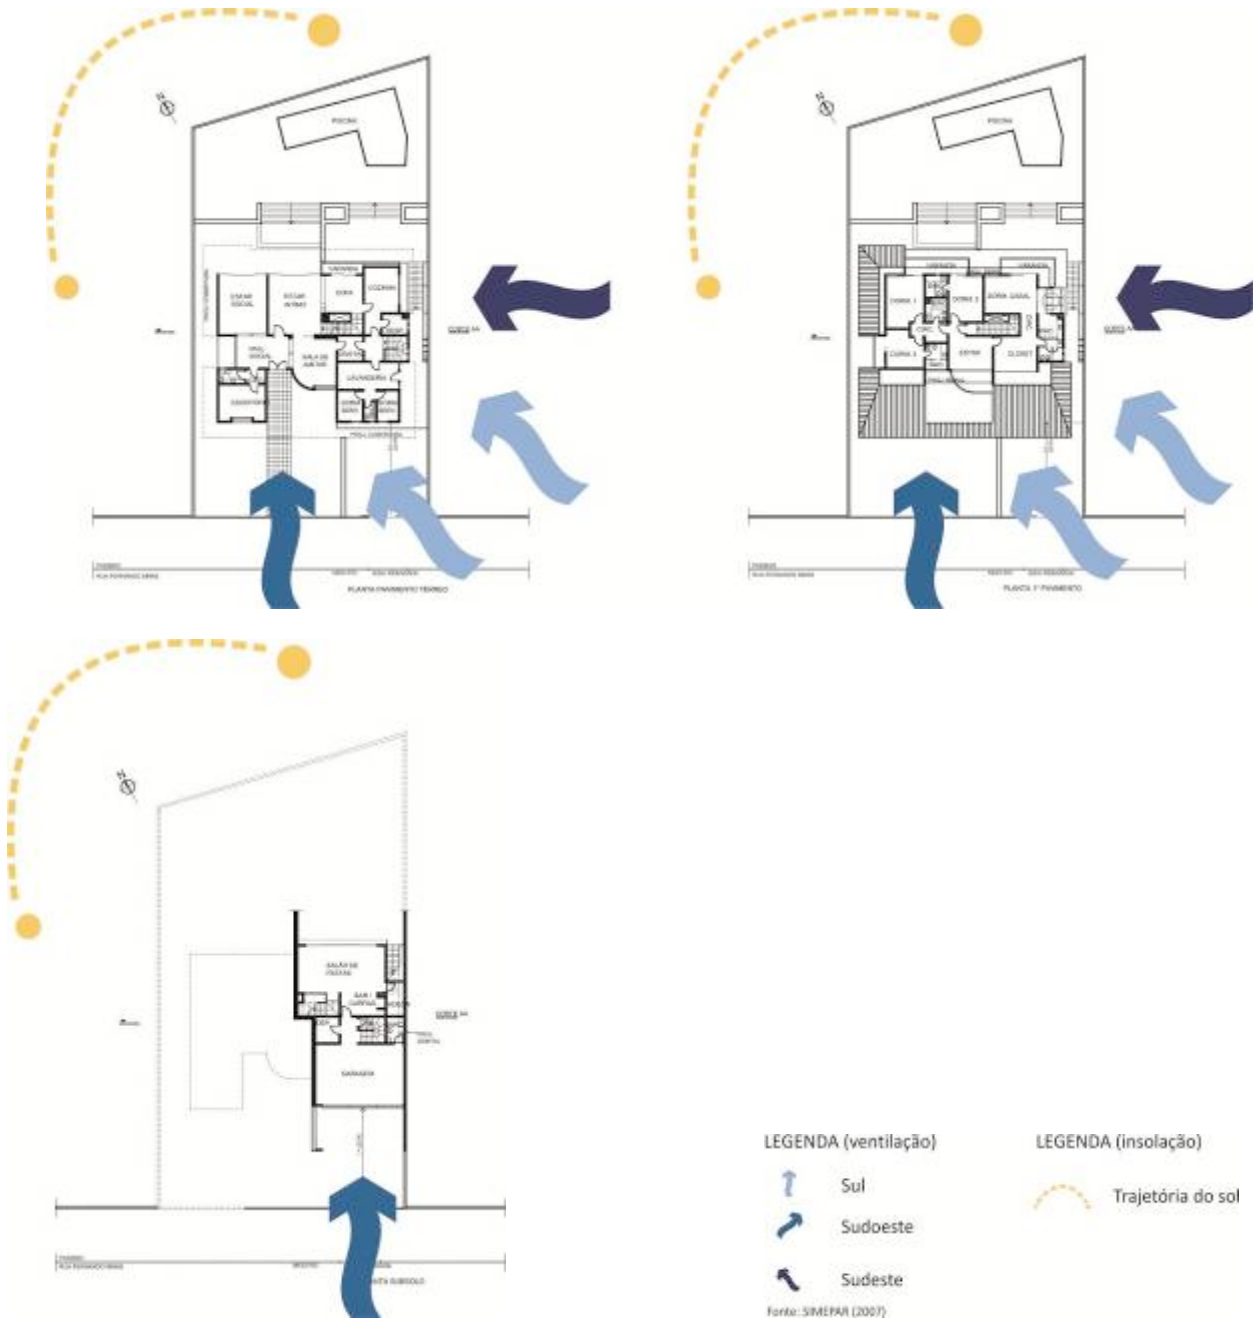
Plantas Pav. Térreo, Superior e Subsolo – Ventilação e insolação.
